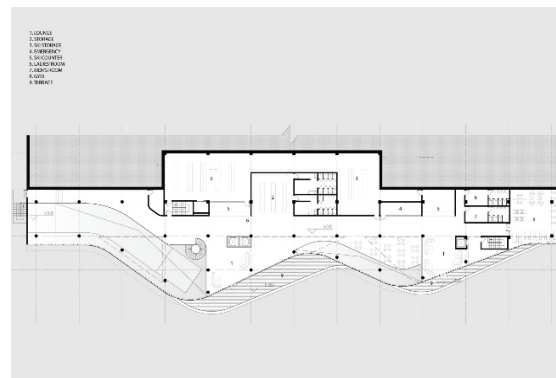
План 2-го этажа ВГК «Yunmen Mountain».
